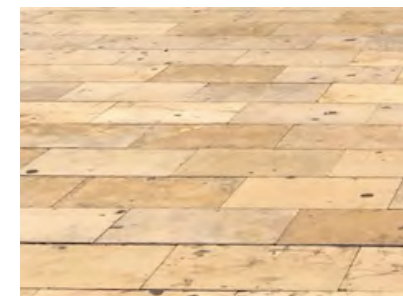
Pavimento utilizado en este tramo a excepción de las zonas de calzada
